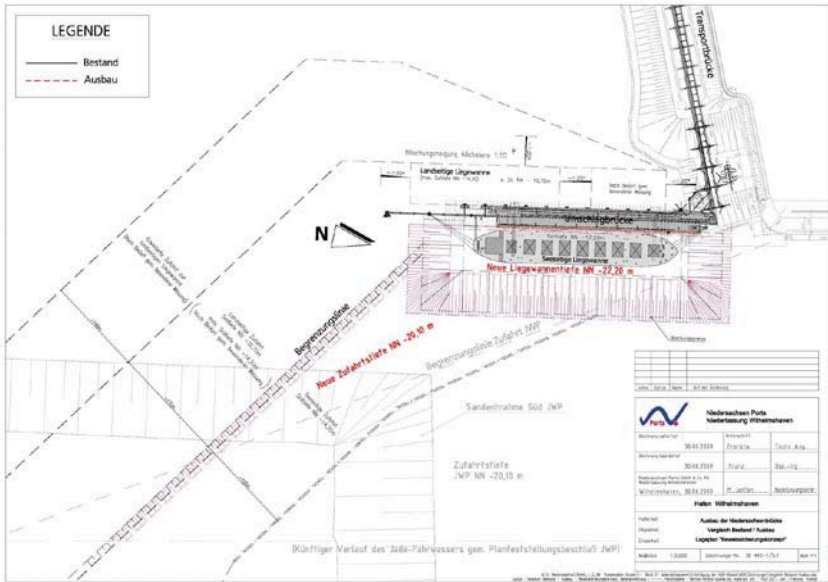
Lageplan Niedersachsenbrücke (Grafik: NPPorts)
